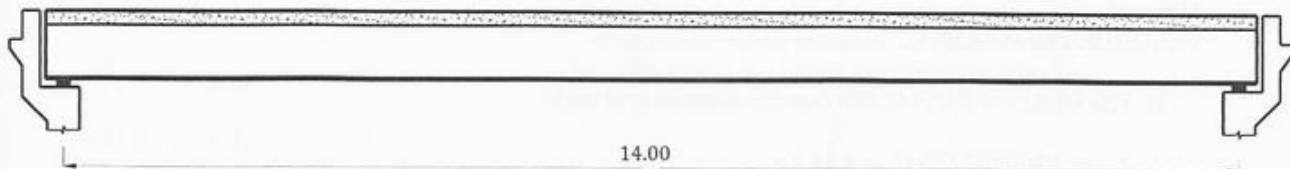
Sección longitudinal del Puente (Ejemplo 14.2)
